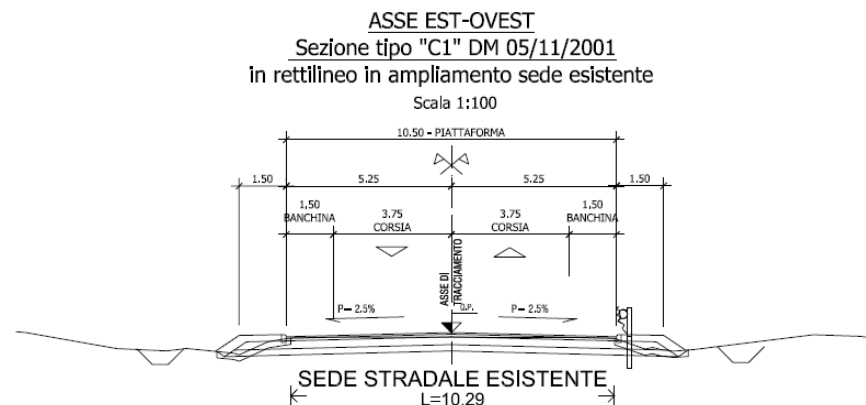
Sezione tipo in rilevato (ampliamento sede esistente)
